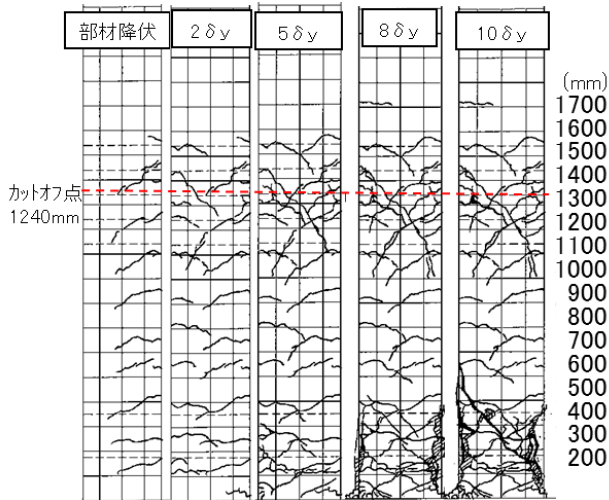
主な荷重ステップのひび割れ状況 (D-15)
